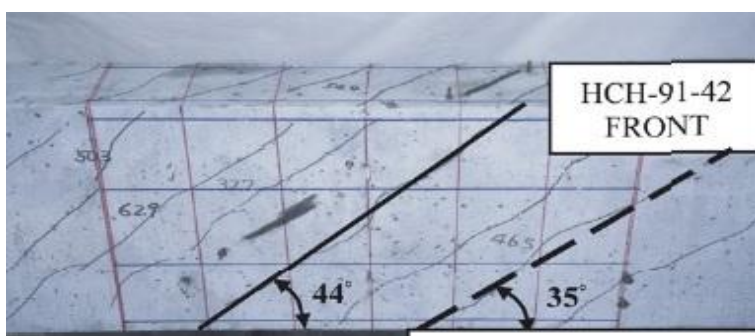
Exemplo do registo da fissuração para uma viga ensaiada por Fang, Shiau, Shiu e Young[18].
